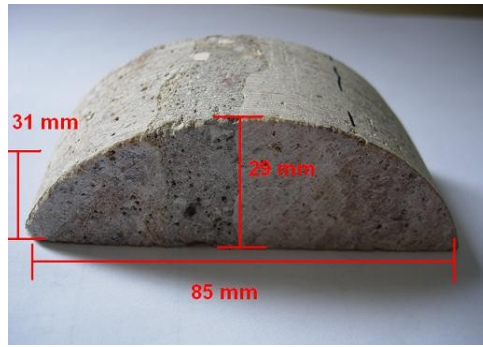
Exemple d'éprouvette composite pour l'essai de flexion.
